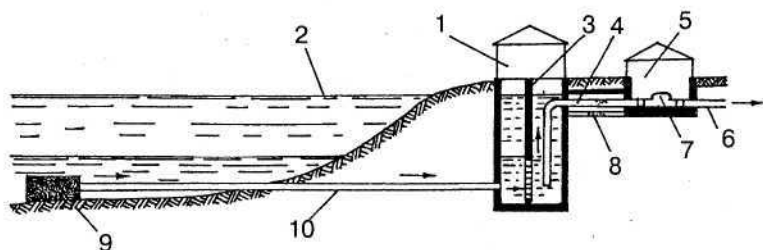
Схема водозабора руслового типа: 1 — колодец; 2 — самотечная линия; 3 — сетка; 4 — всасывающий трубопровод; 5 — насосная станция; 6 — напорный водовод; 7 — насосы; 8 — галерея трубопроводов; 9 — оголовок с решетками; 10 — самотечный водопровод
